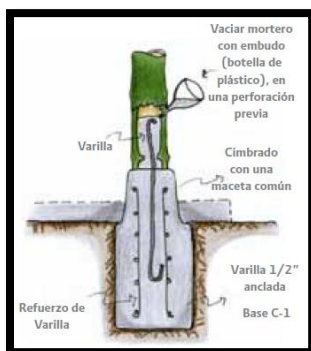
Anclaje en columnas con elementos verticales incl. refuerzo de acero
